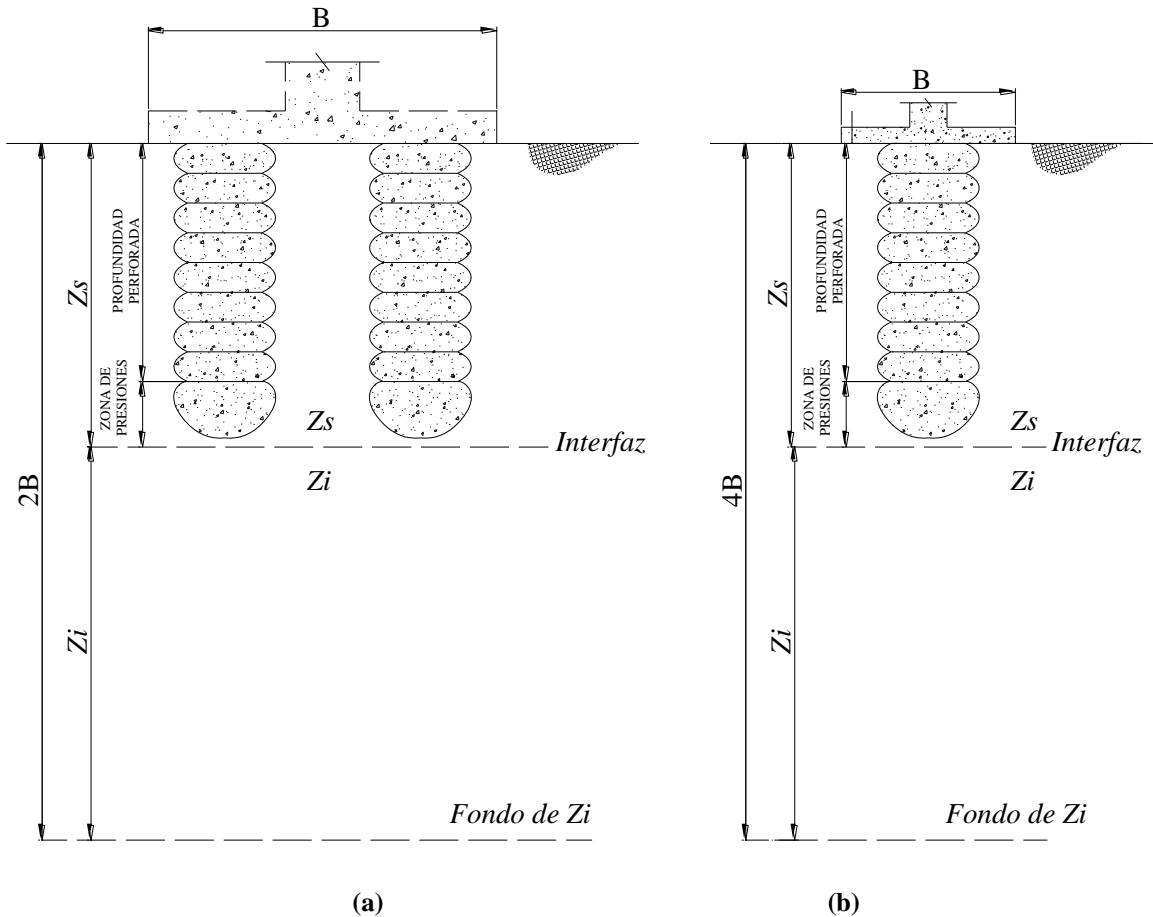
Zona superior y zona inferior, (a) para zapatas aisladas, (b) para zapatas corridas.
